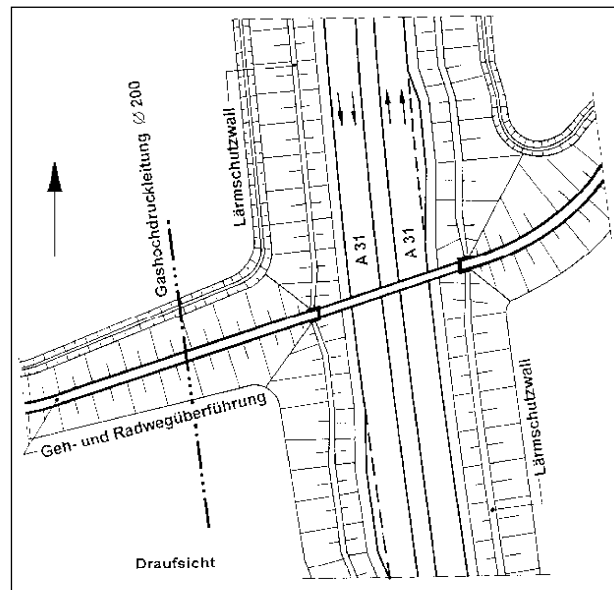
Lageplan der Geh- und Radwegüberführung mit kreuzender Gashochdruckleitung
